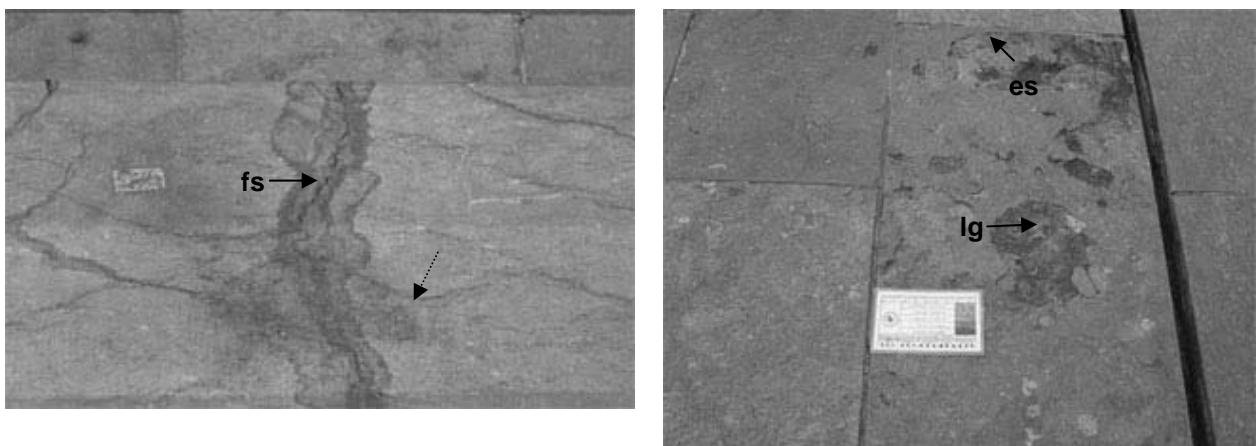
A) Fissuração (fs) e acréscimo da fissuração (···▶) em chapas de calcário usadas em escadaria. B) Lascagem (lg) e esfoliação (es) em pisos exteriores. Centro Administrativo La Alpujarra.
